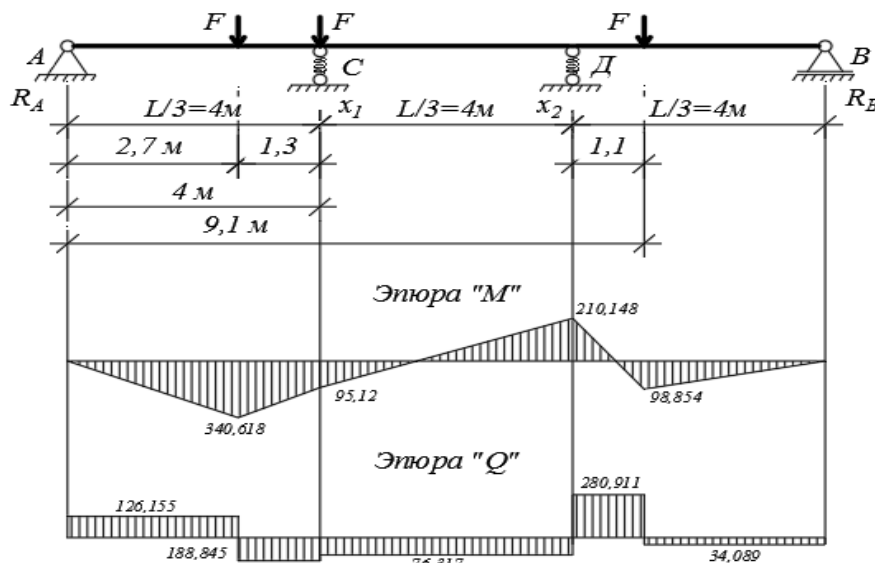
Эпюры M и Q для второго варианта загрузки подкрановой балки
